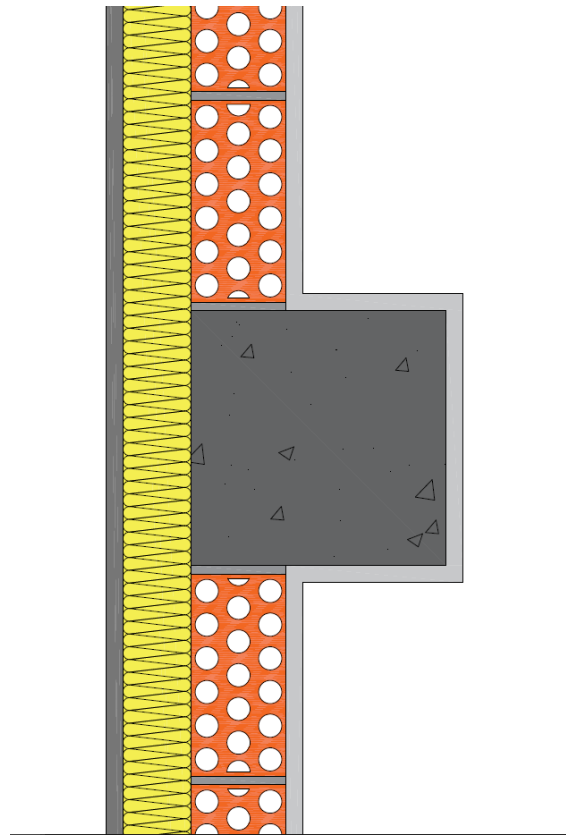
Detalle de solución constructiva para evitar puentes térmicos en pilares integrados en fachada.
